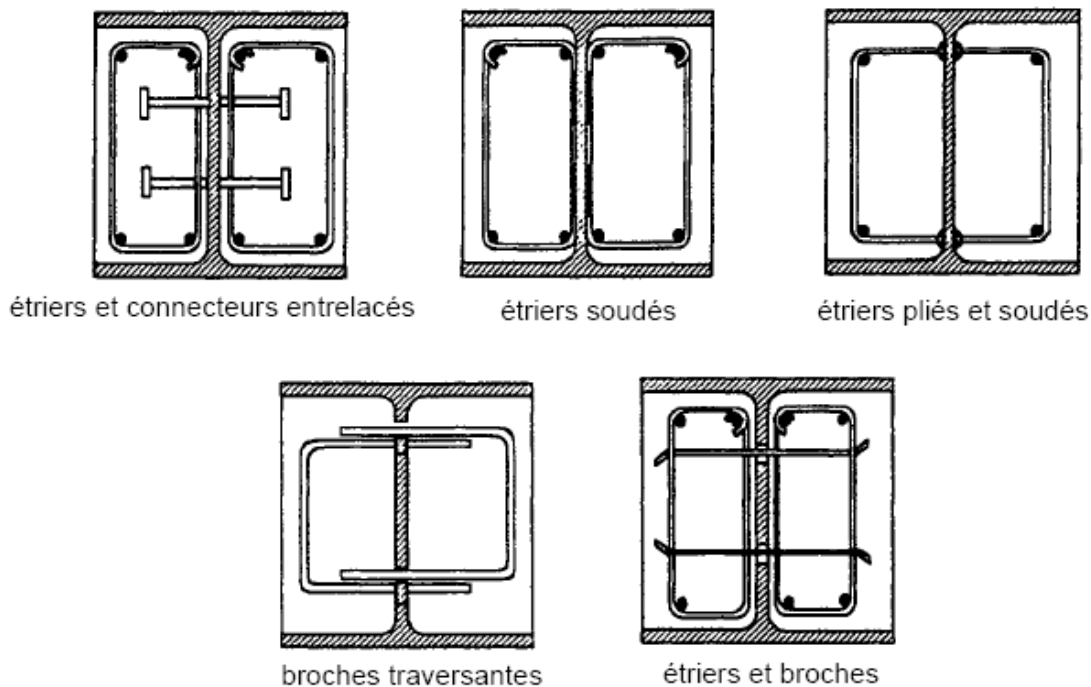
Exemples de connexions assurant une liaison entre éléments structuraux
